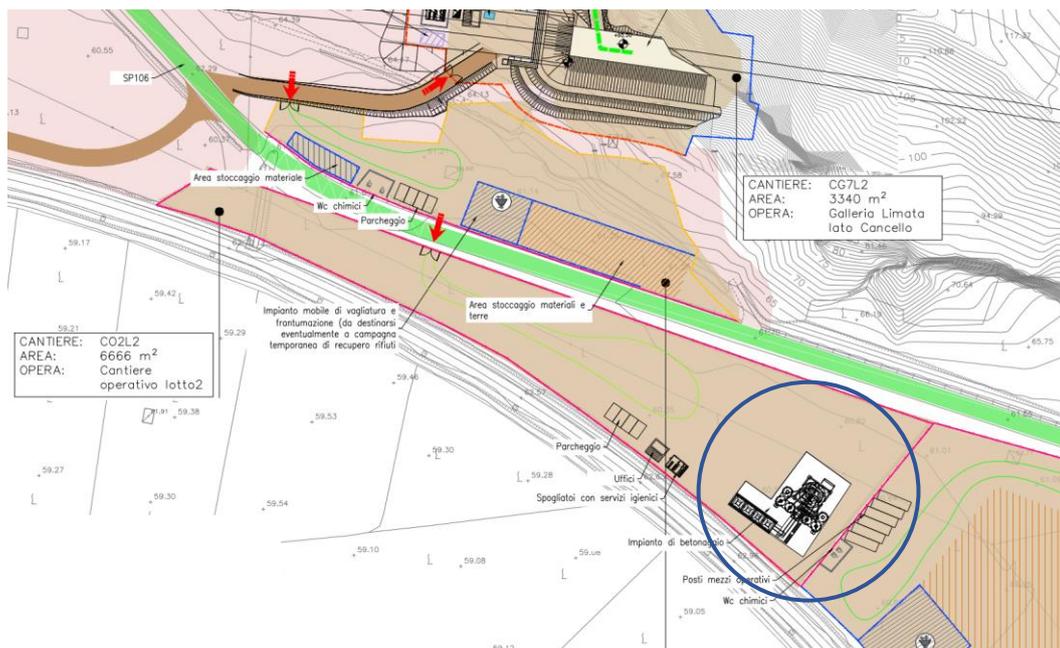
Area CO2L2 con indicazione dell'impianto di betonaggio
